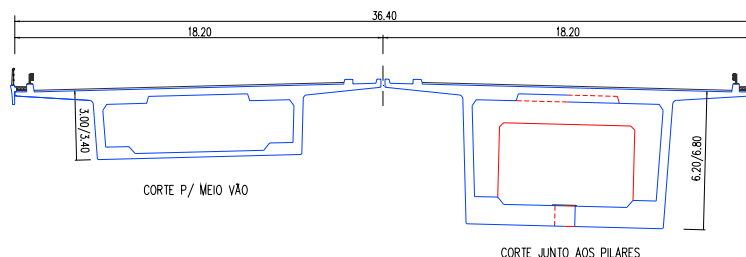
Secções transversais dos tabuleiros em viga-caixão.
